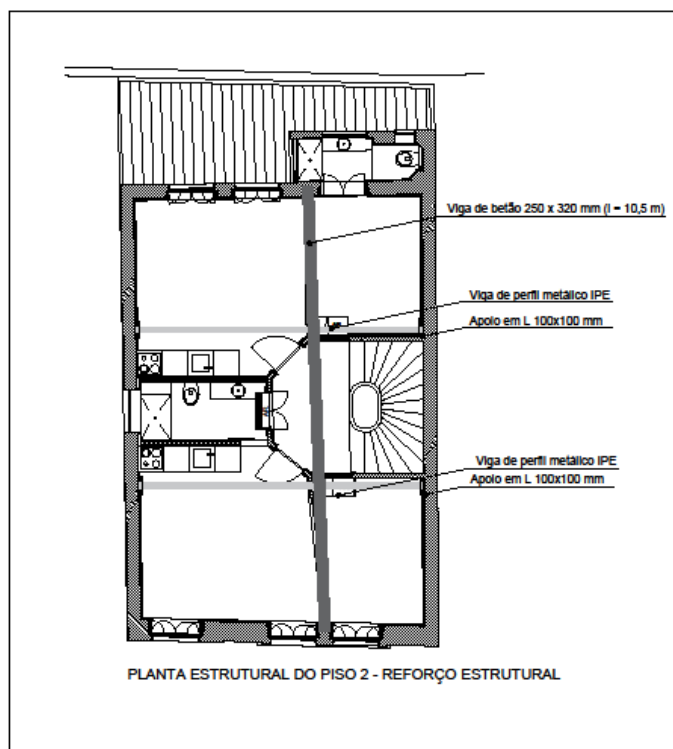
Planta estrutural do Piso 2 - Reforço estrutural
